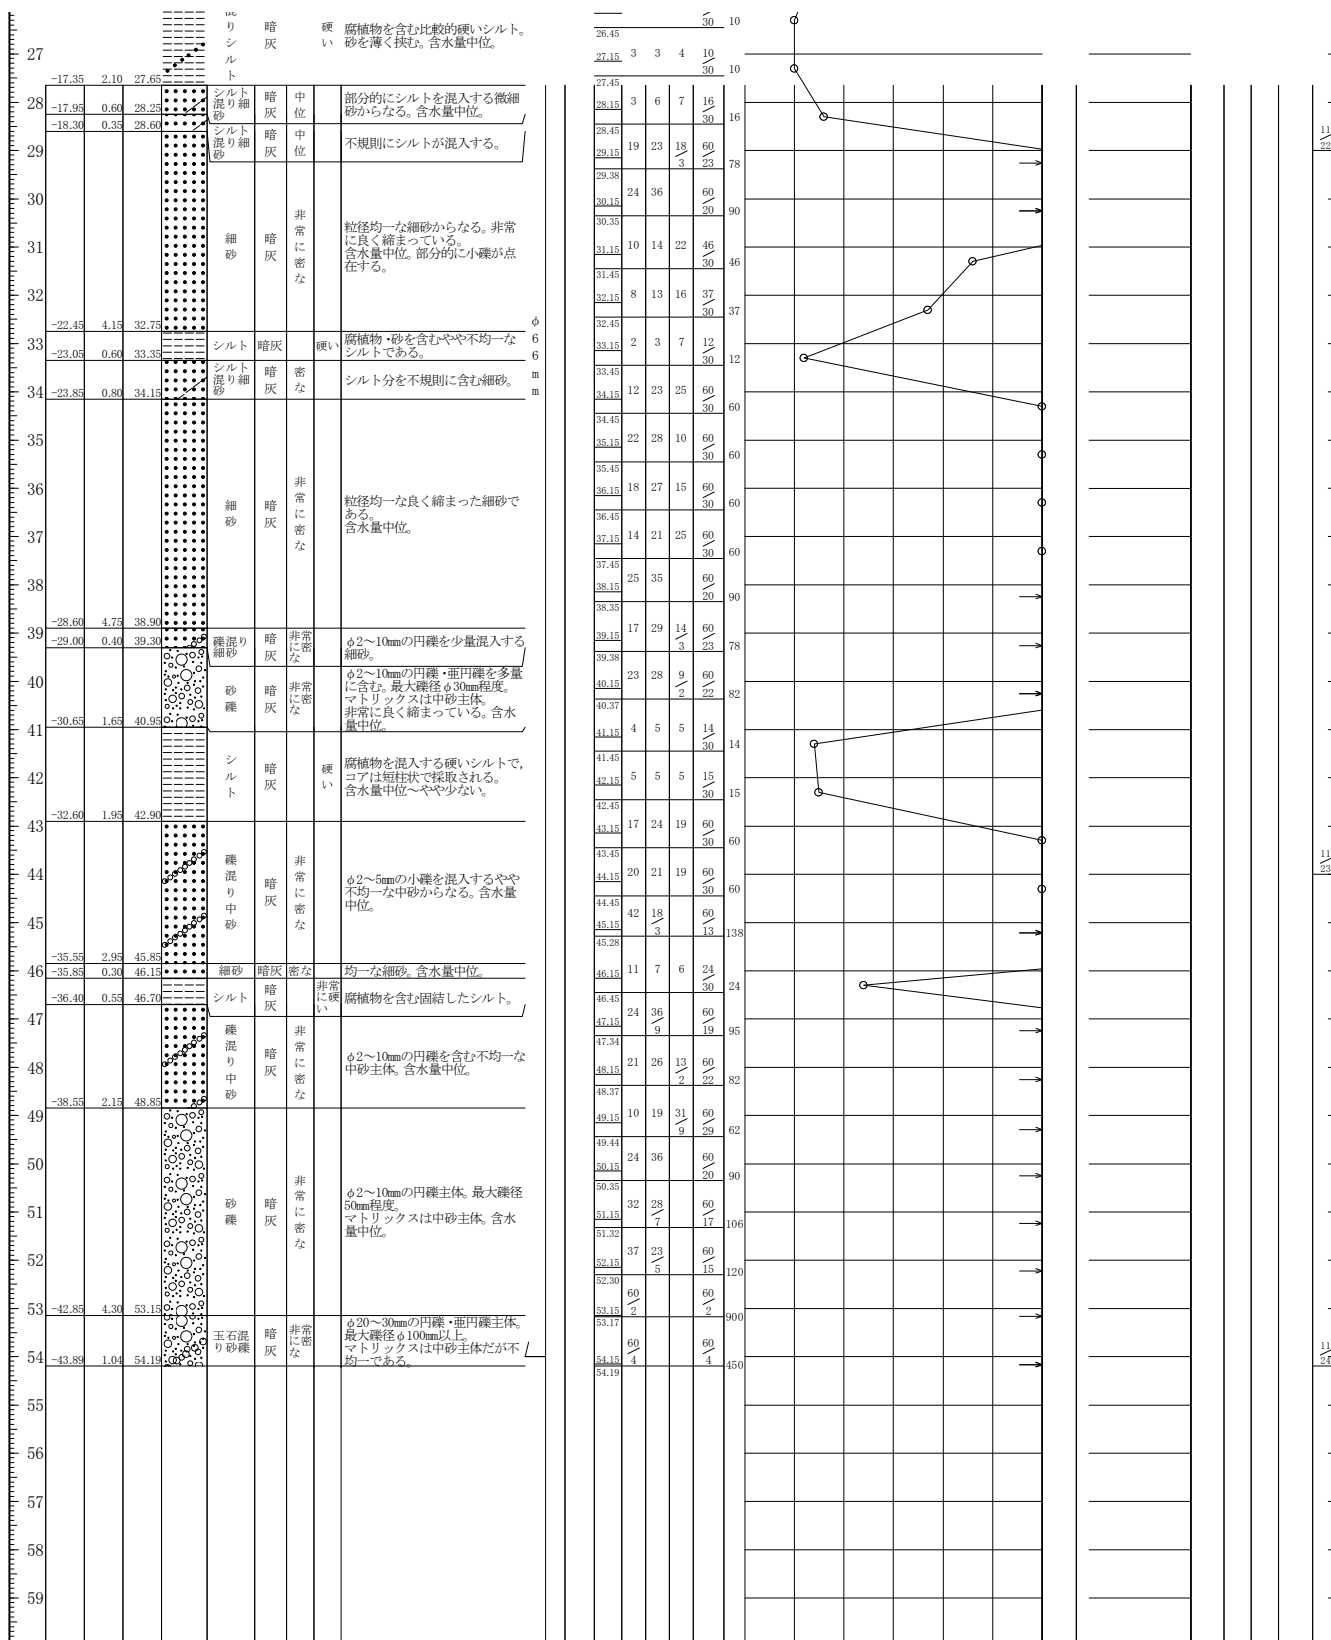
(1) ボーリング柱状図 (No.6-1)
